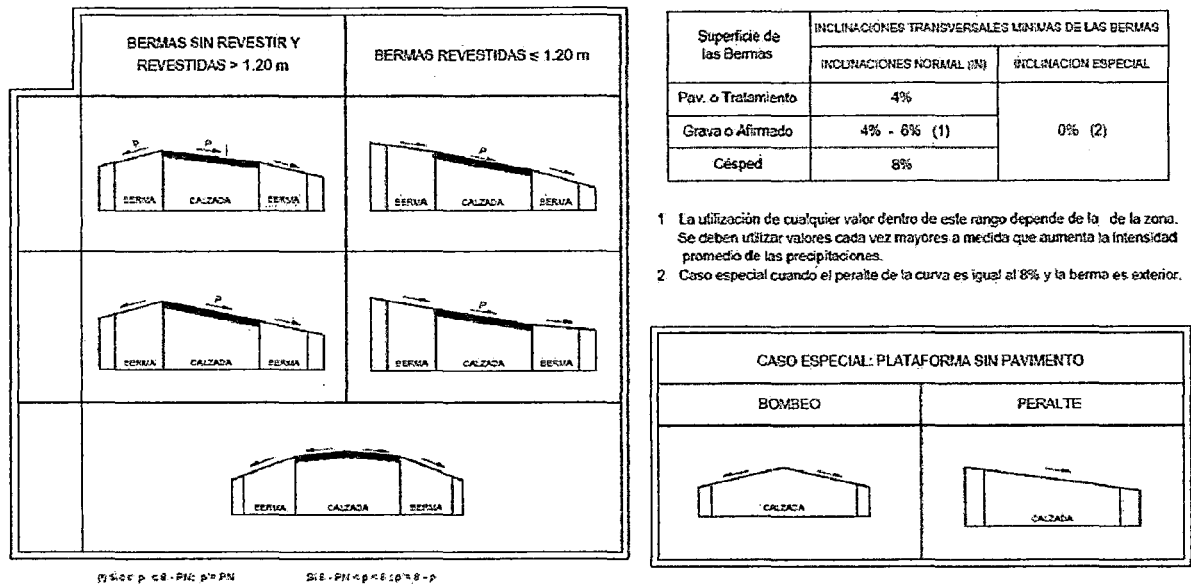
Inclinación transversal de bermas - Fuente[2]
